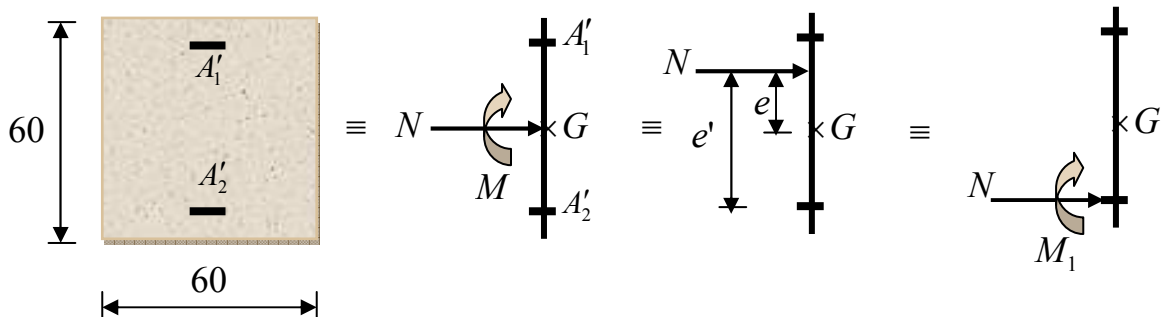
Position de N_1 et M_1 sur la section transversale.
